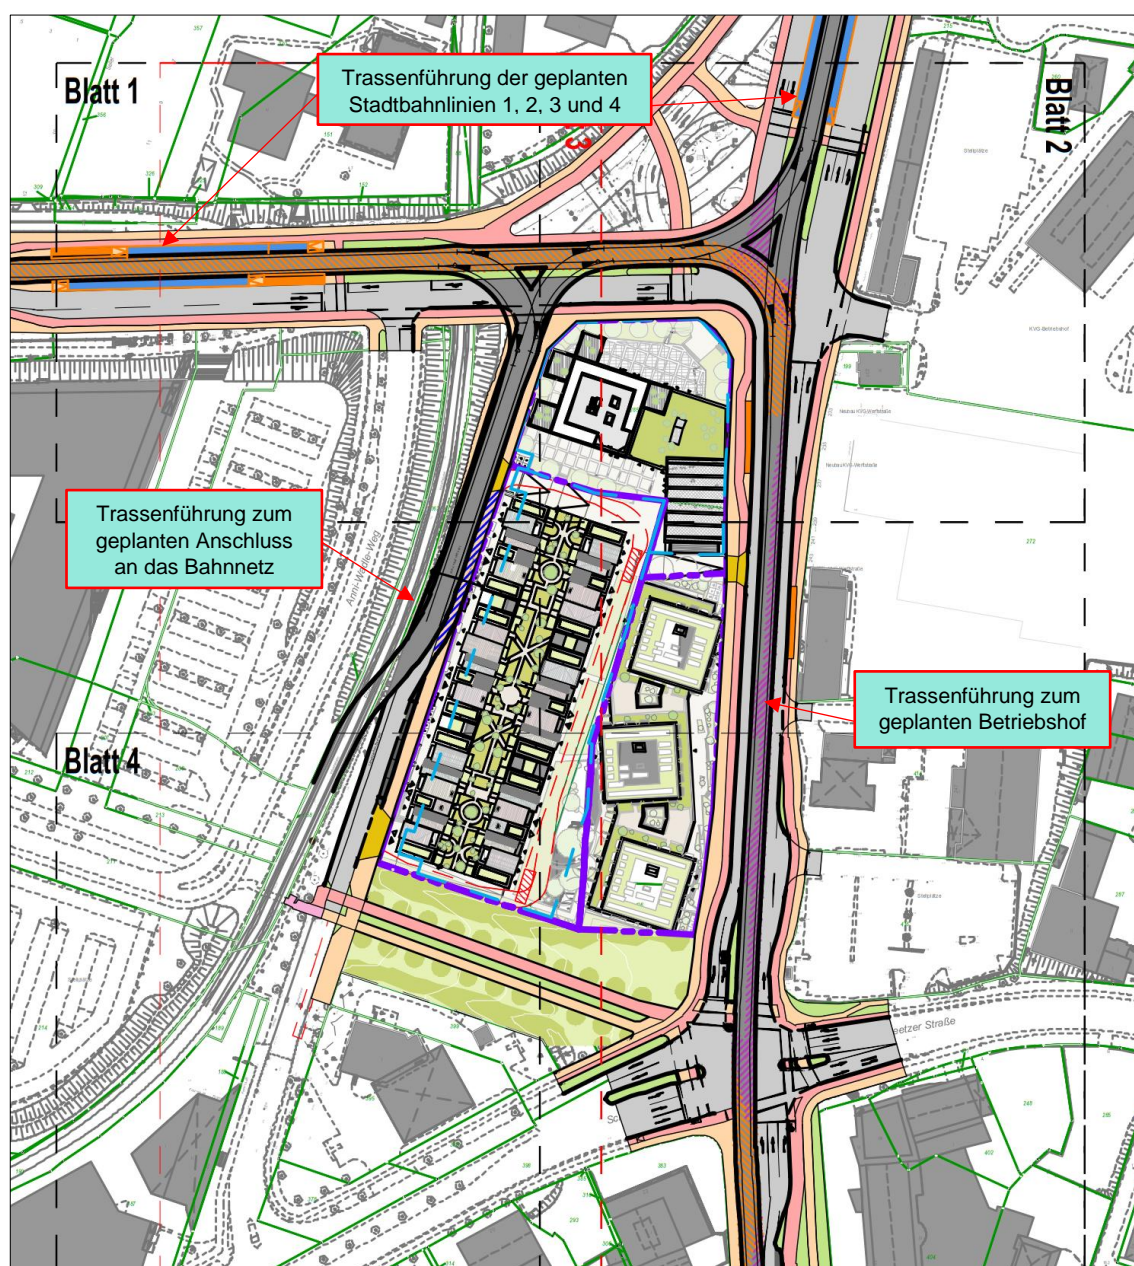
Mögliche Führung einer Stadtbahntrasse [3]
